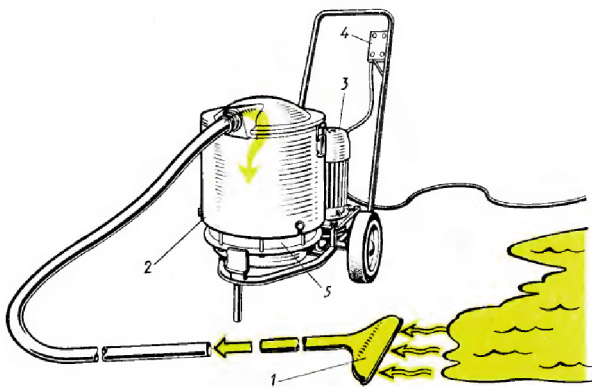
Машина СО-106А для удаления воды с основания кровли:
